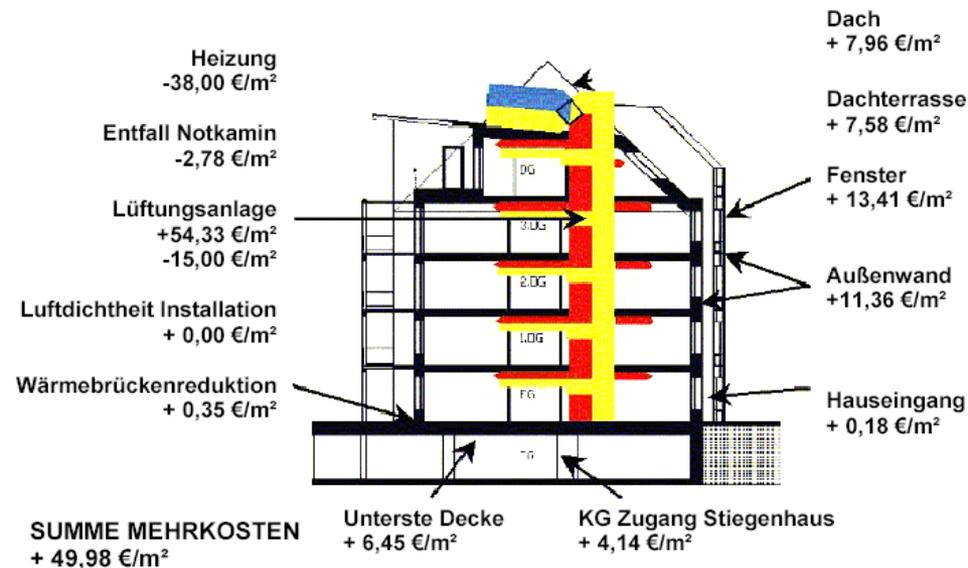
a Graphische Darstellung der baulichen Mehrkosten bei der Errichtung des Passivhauses Dreherstraße [Schöberl & Pöll] Stand 04.2006, Euro exkl. UST
